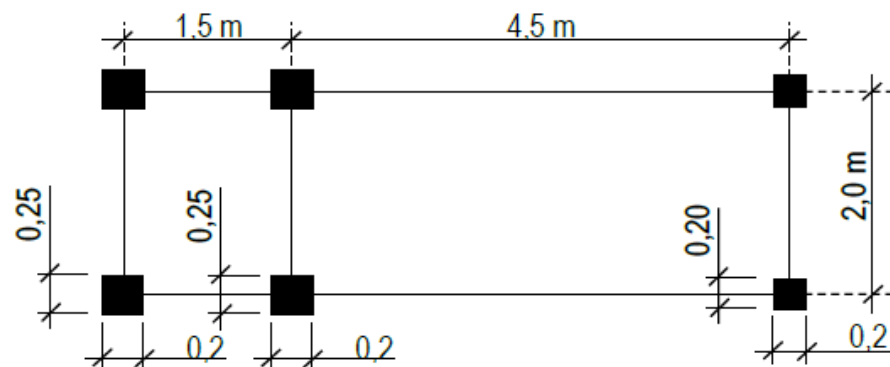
disposition du chargement Bc dans le sens transversale et vue en plan
